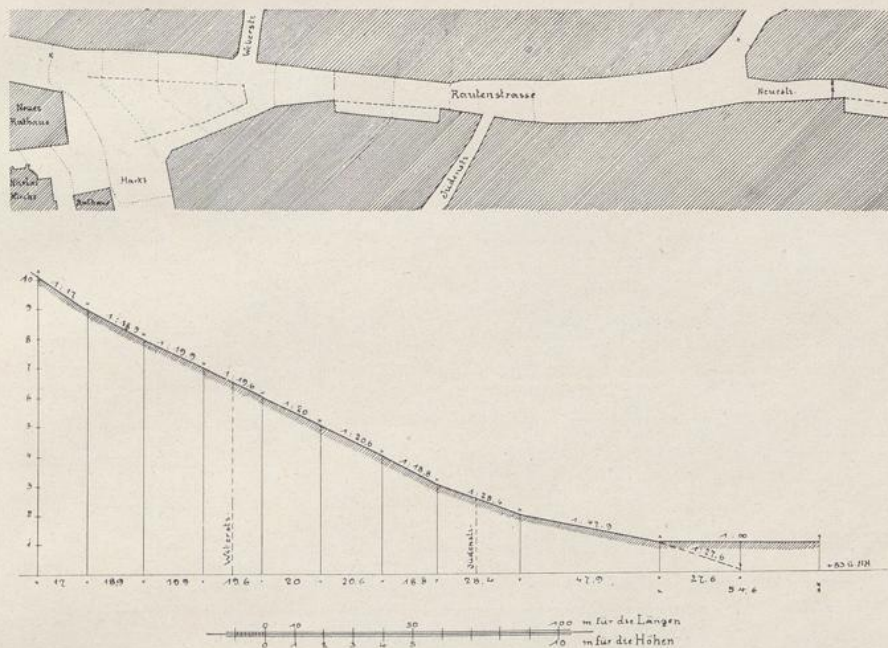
Konkaves Längsprofil (Nordhausen, Rautenstraße).
